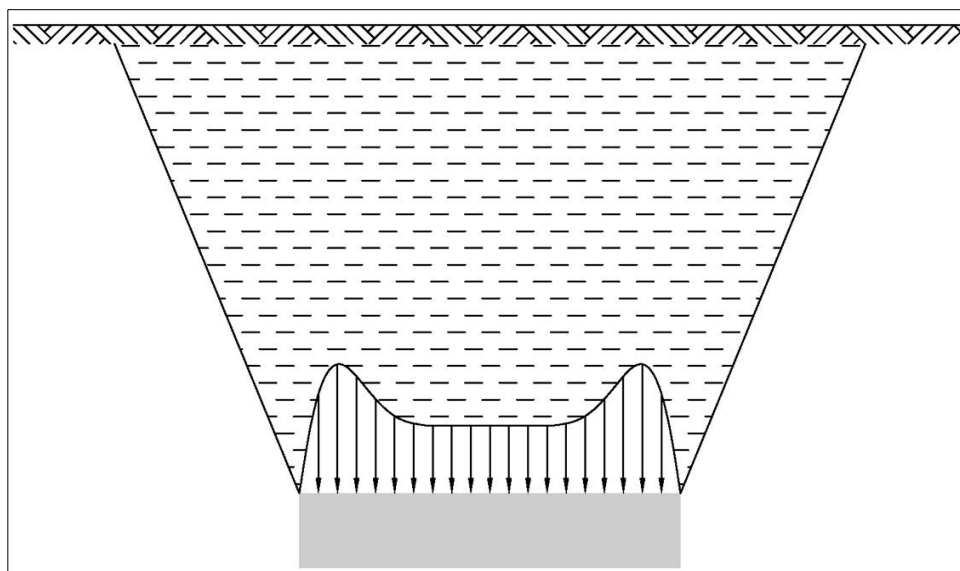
Схема для определения нагрузки на целик угля
